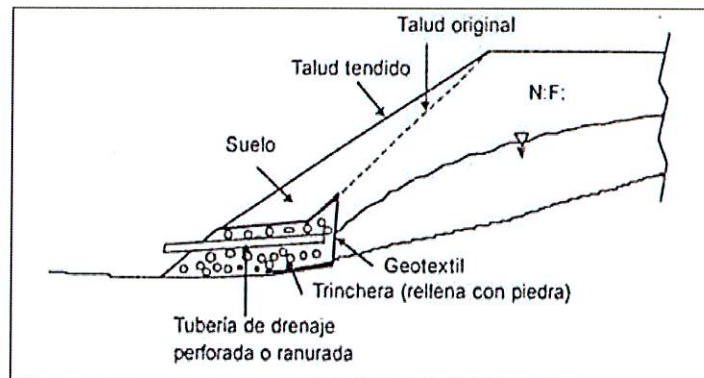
Sección transversal de drenaje interno por trincheras con relleno de piedra (adaptado de FHWA, 1988).
